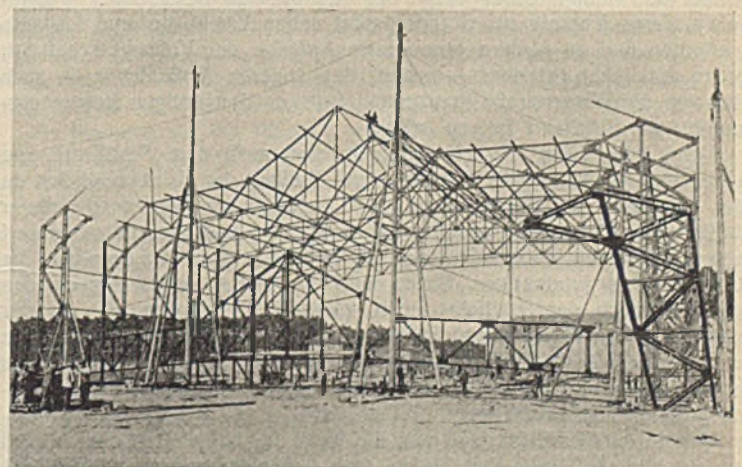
Halle für Großkampfflugzeuge in Zeesen. (Zusammenbau der Binder.)
